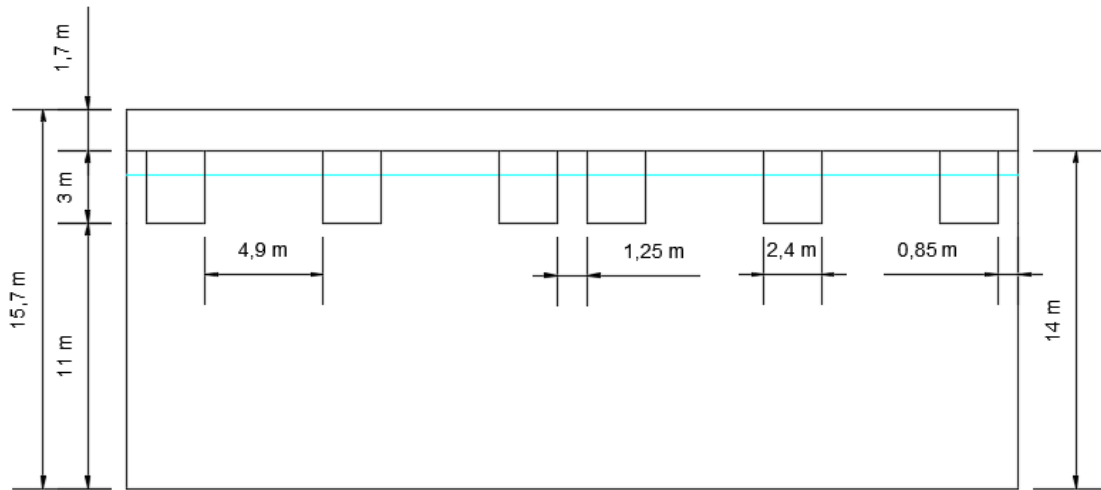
Geometría del cajón antirreflejante en alzado para las ondas de infragravedad. Fuente: Propia
